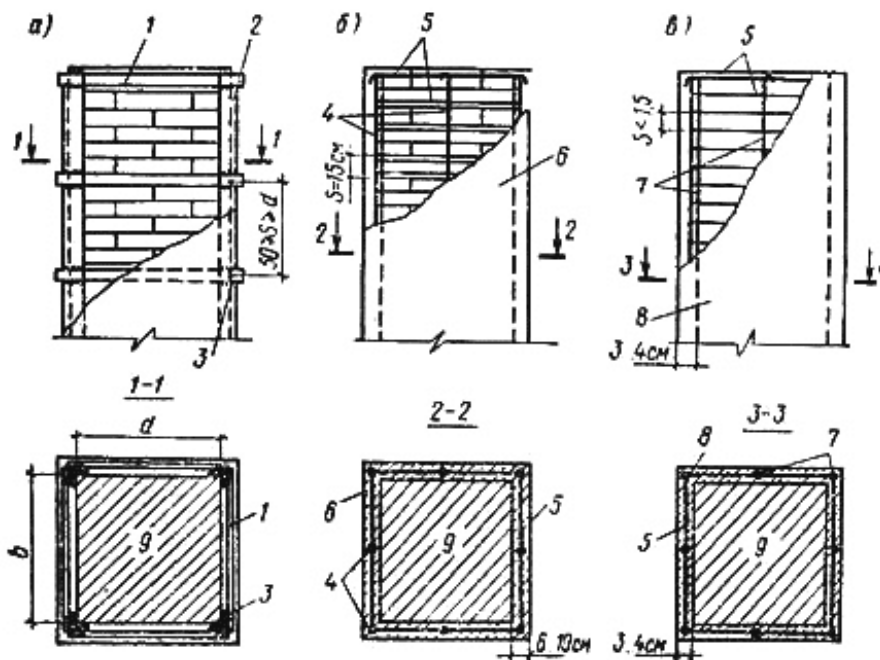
Усиление каменных столбов стальной (а), железобетонной (б) и армированной раствором (в) обоймами: 1 – планки 35х5...60х12 мм; 2 – уголки; 3 – сварка; 4 – стержни  $d = 5...12$  мм; 5 – хомуты  $d = 4...10$  мм; 6 – бетон В12.5...В14; 7 – стержни  $d = 6...12$  мм; 8 – раствор марки 50...75; 9 – кладка
